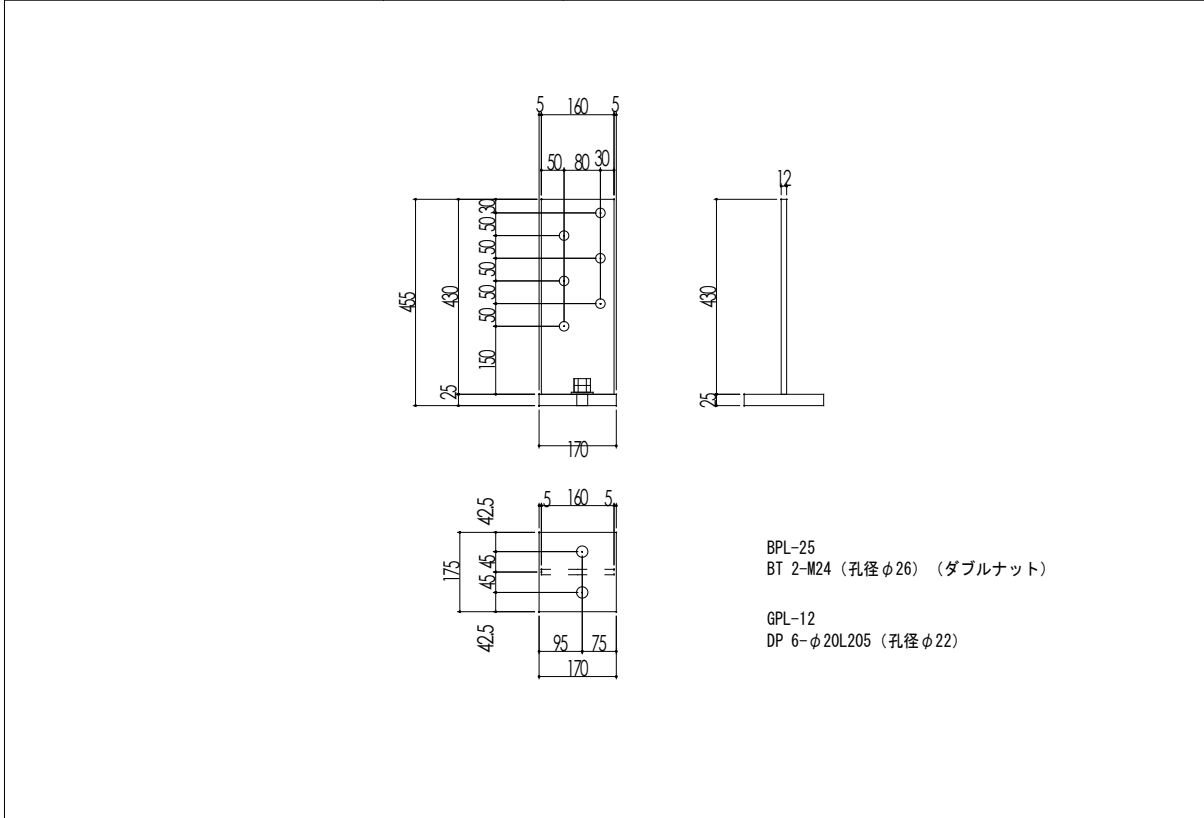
一般階垂れ壁(WG)接合金物詳細図 (2)
